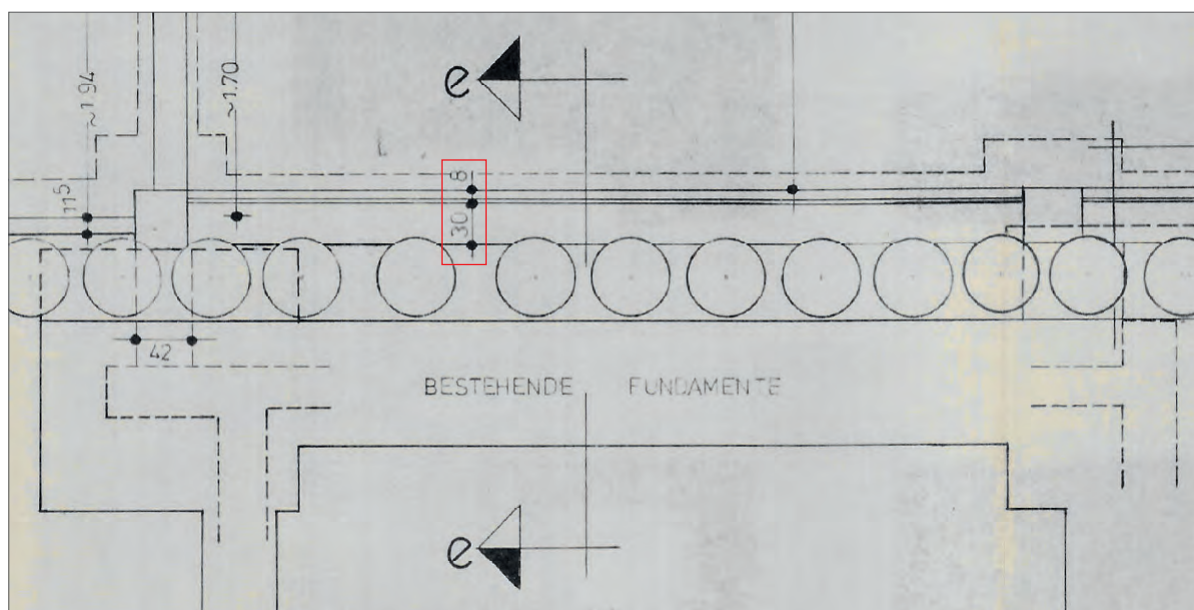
Werkplan Grundriss/Architekturbüro H. Theurer u. H. Dutt (Auszug) [1]
